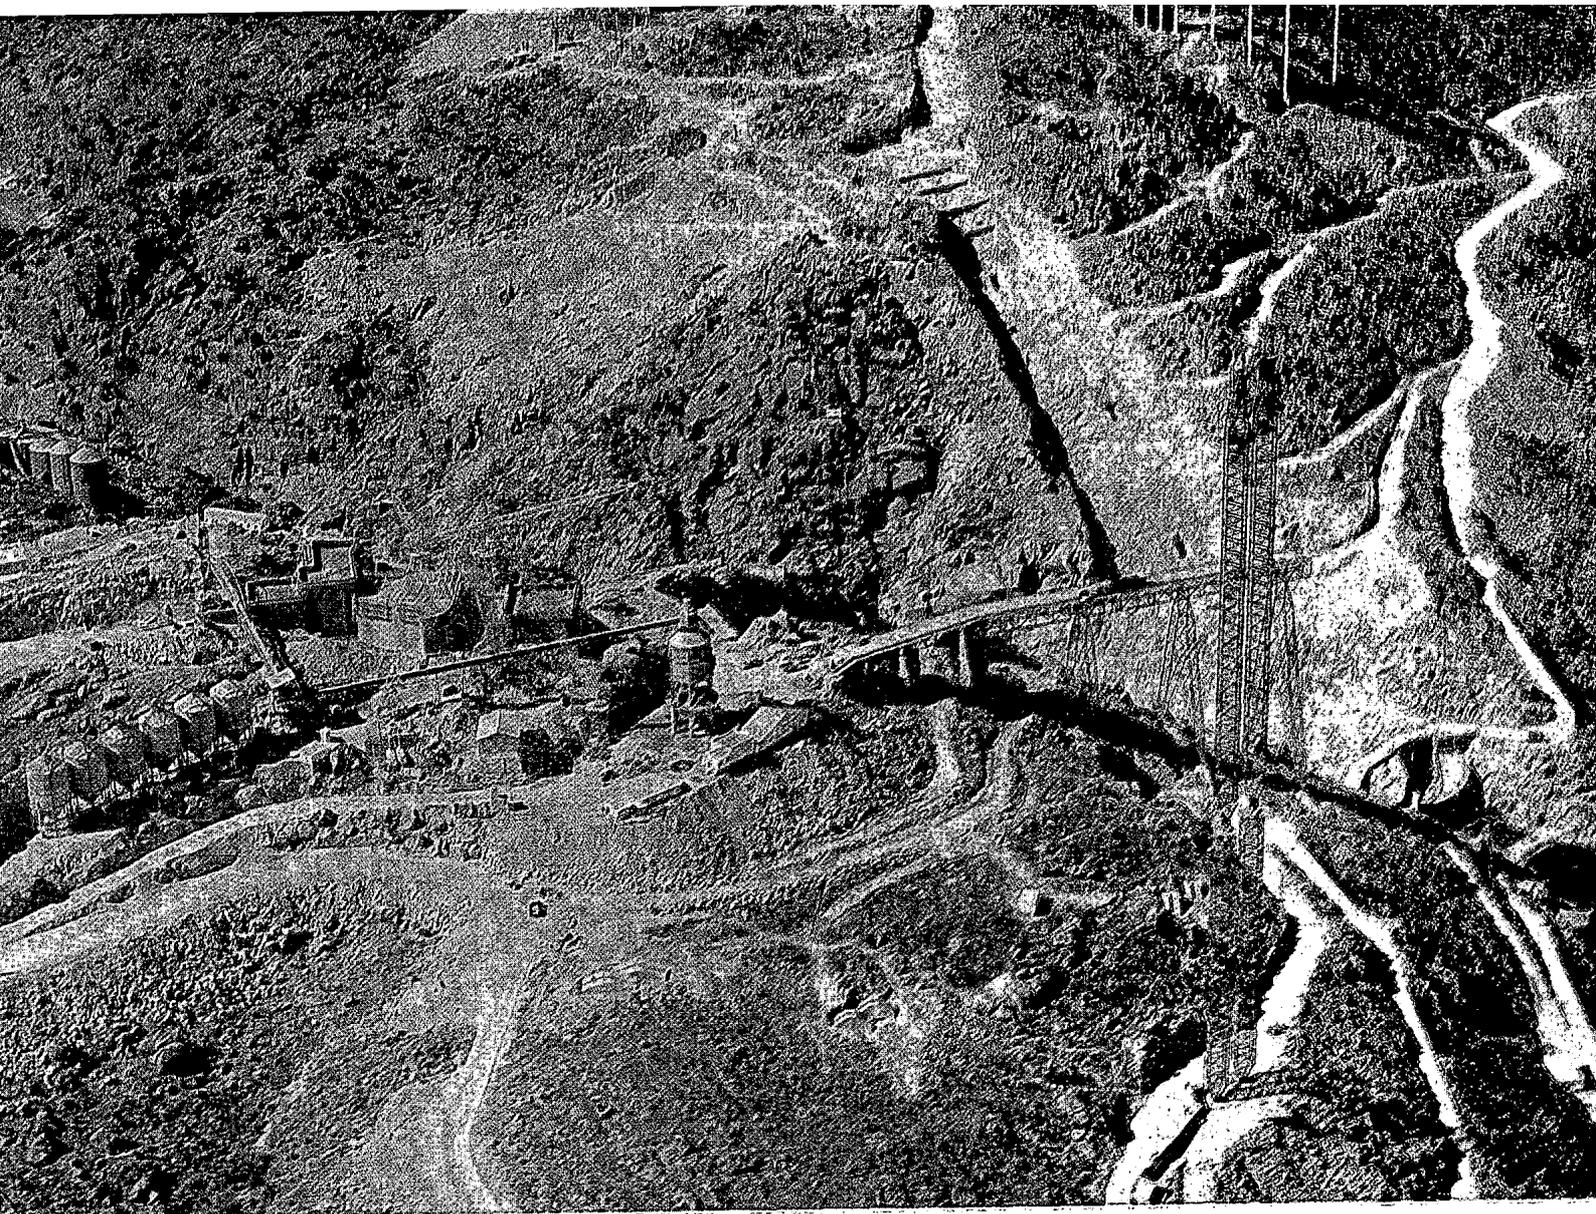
^a — Vista general de las instalaciones de puesta en obra del hormigón en la presa de Almendra, de IBERDUERO, S. A.
